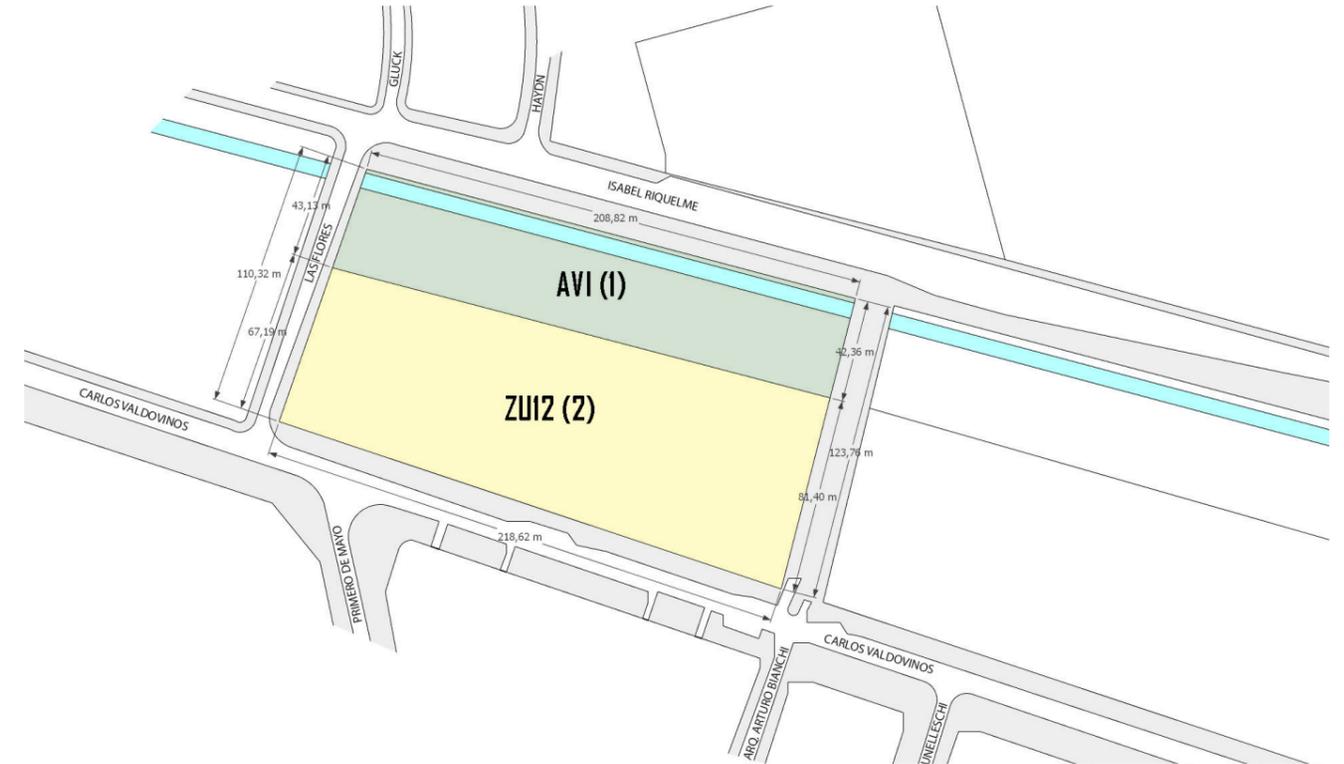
Planta polígono a intervenir. Fuente: Elaboración propia en base a plano Municipalidad San Joaquín
